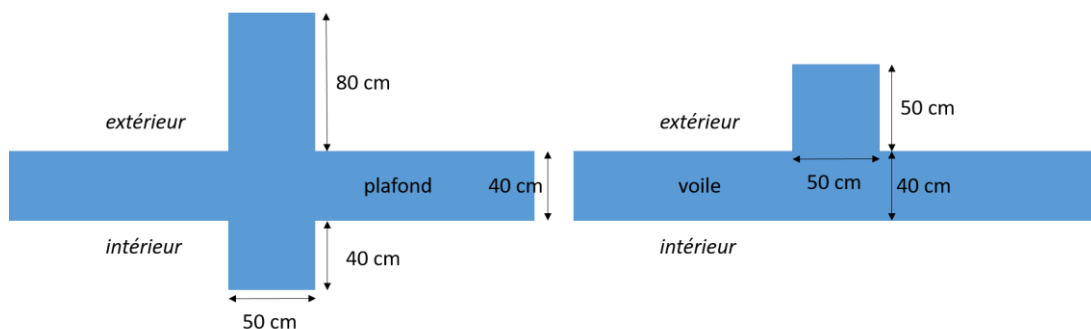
Sections des poutres et poteaux sur les cinq portiques centrales
